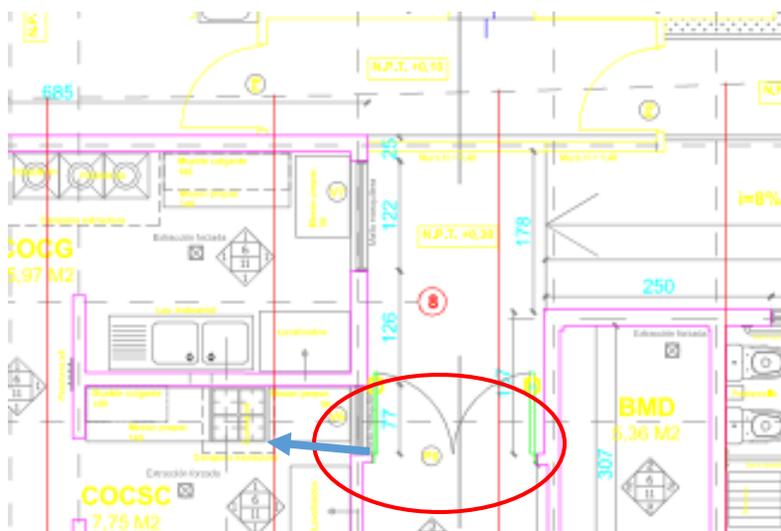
Planta Primera en zona de puerta de Acceso a zona de servicio. Fuente Obra Sala Cuna Bosquemar, Constructora Molina Asenjo. Mirasol Puerto Montt
